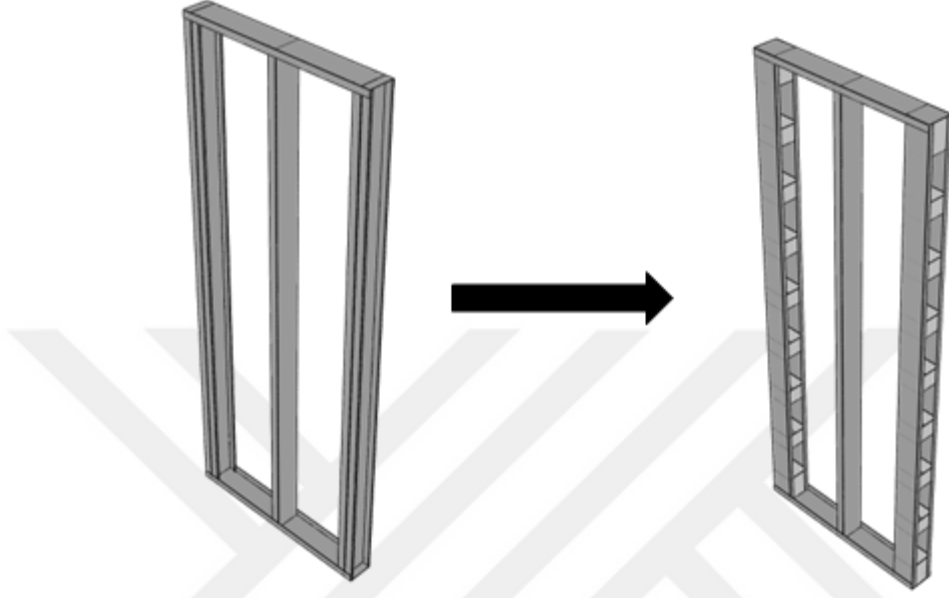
Yapma kolonun geometrik detayları (Birim: mm)
